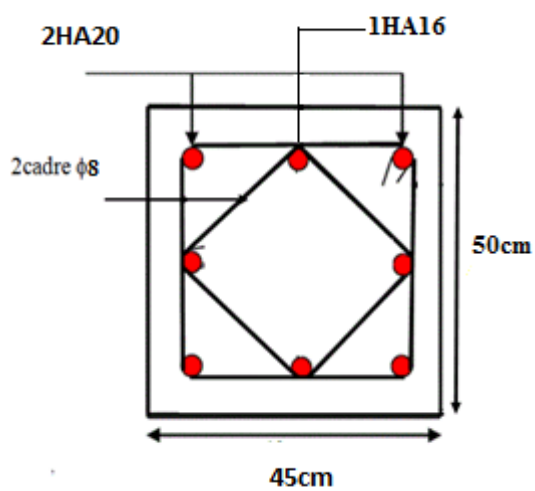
Schéma de ferrailage des poteaux RDC.
